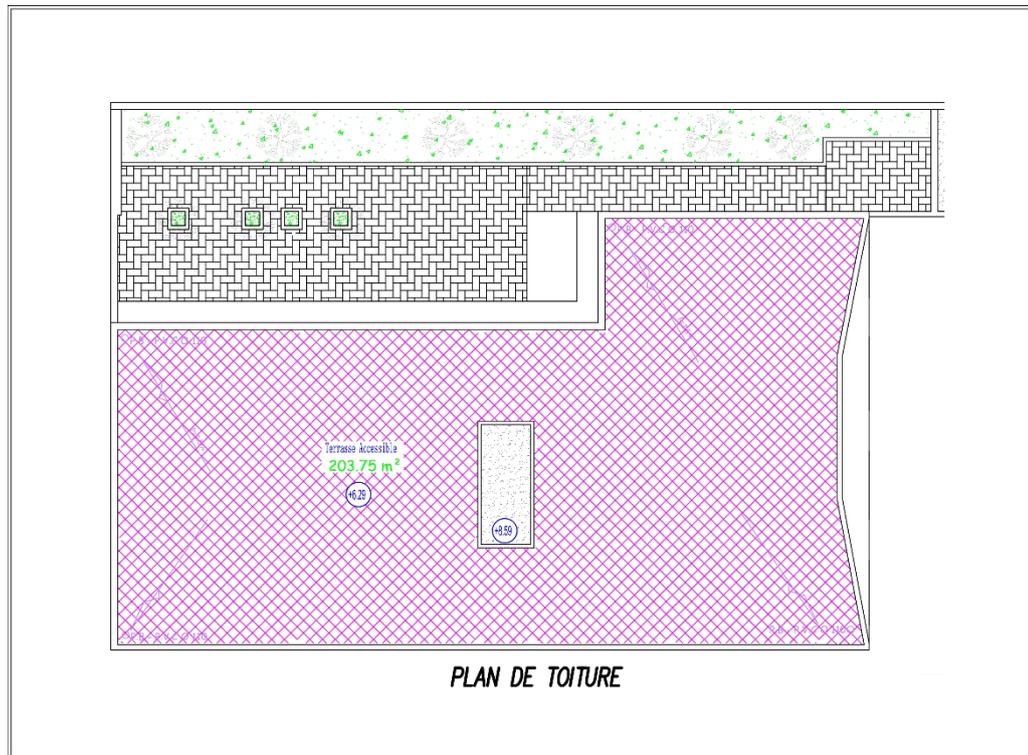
Plan de toiture –modèle N° 01- (Source : Auteur)
